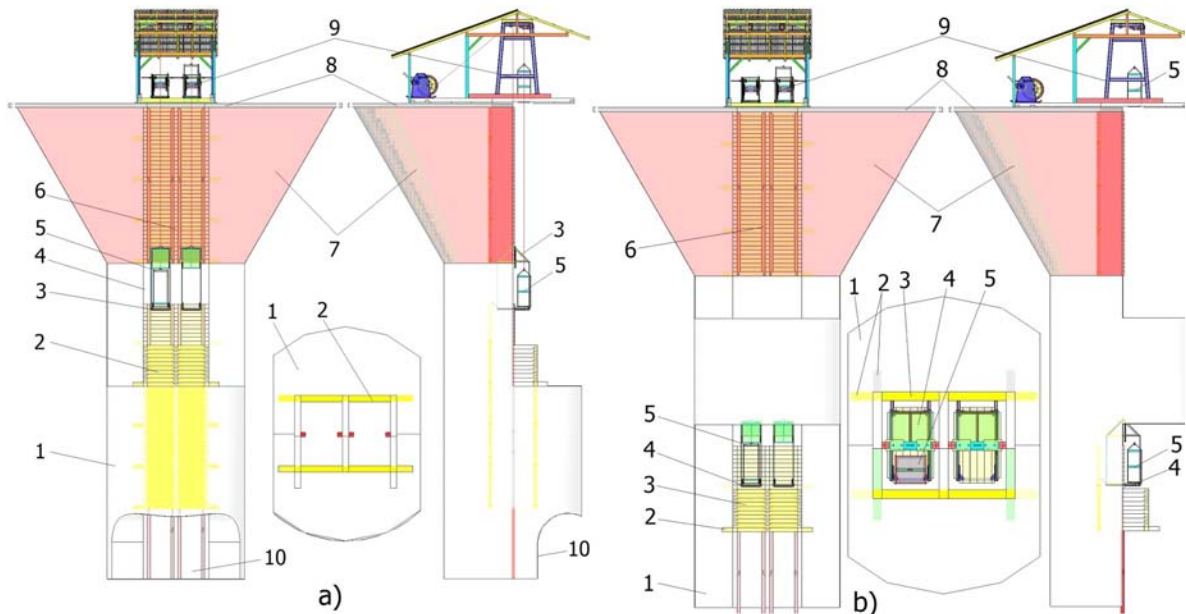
Utilizarea instalației la reabilitarea puțului prin schimbarea armăturii din lemn prin excavare, varianta IV, faza 1 și 2
